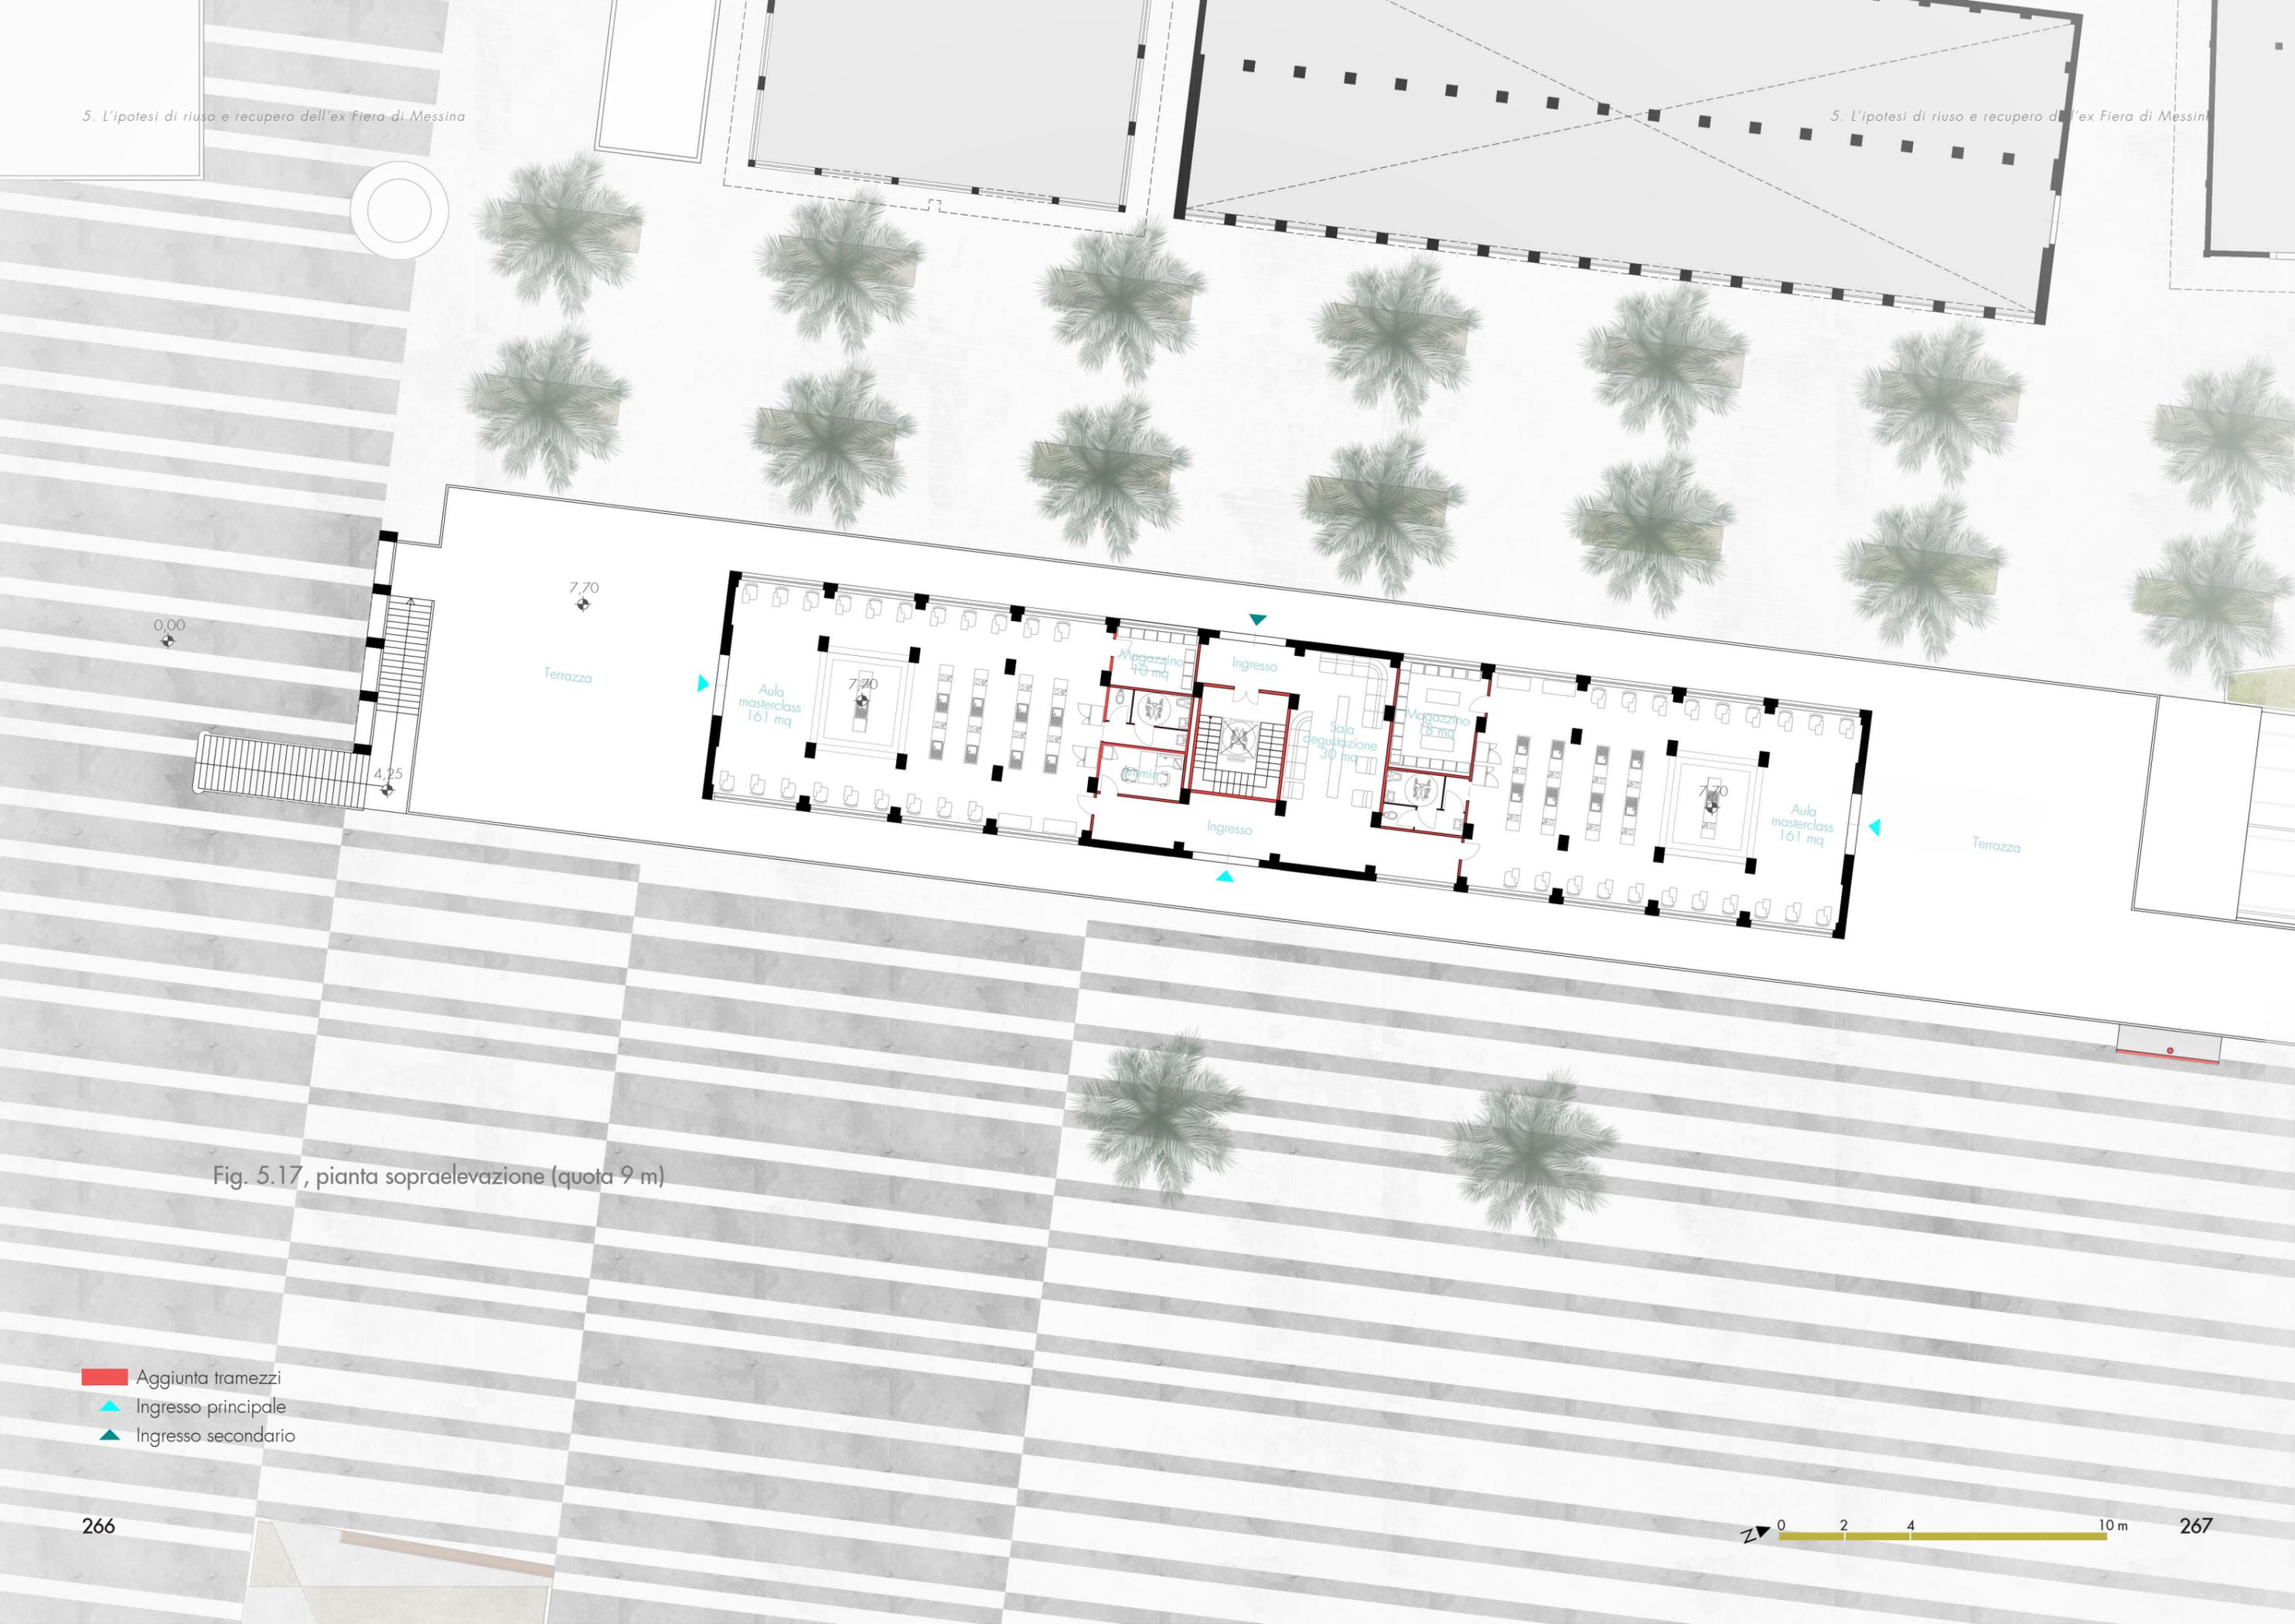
, pianta sopraelevazione (quota 9 m)
